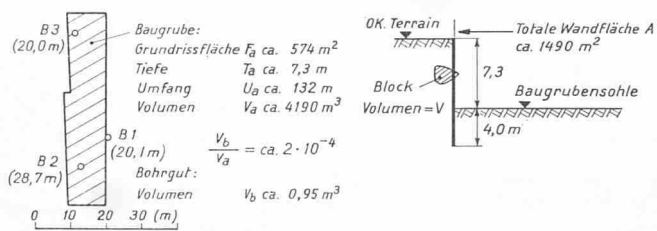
Links: Grundriss-Schema; rechts: Schnitt-Schema
